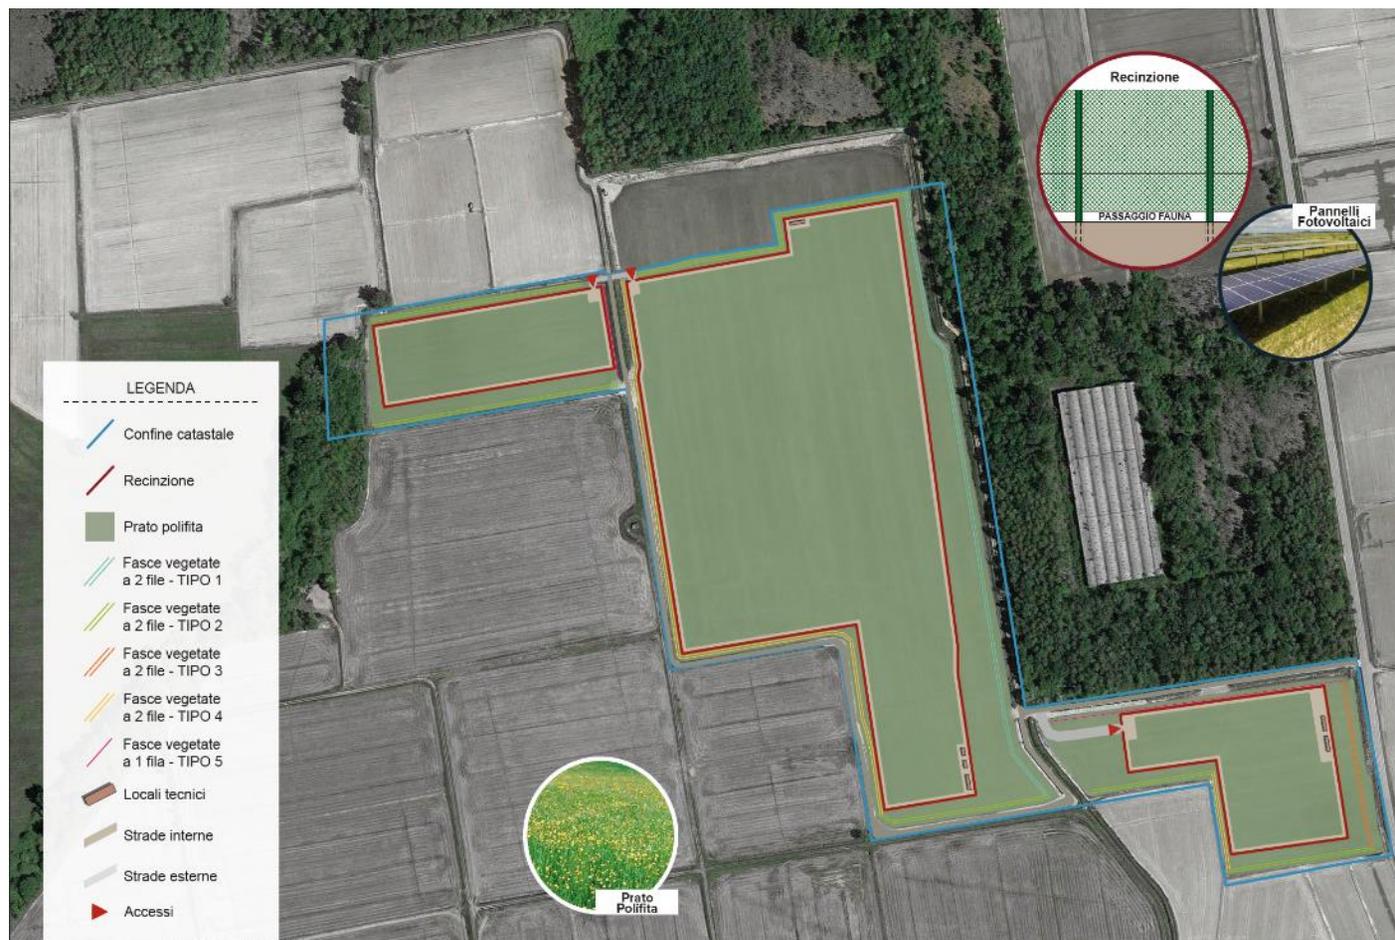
Planimetria dell'impianto di progetto "Fattoria solare Roggia Bardesa" con gli interventi di mitigazione ed inserimento paesaggistico-ambientale (R1)
